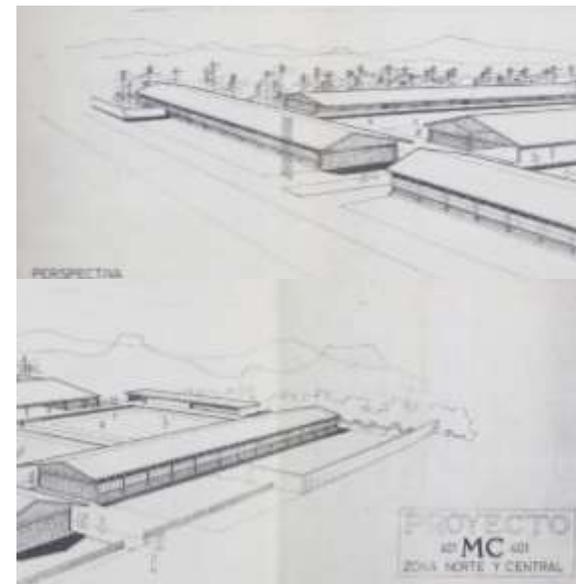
Sistema Constructivo MC Zona norte y central. Fuente: (Stephanie & Cid, 2018)
